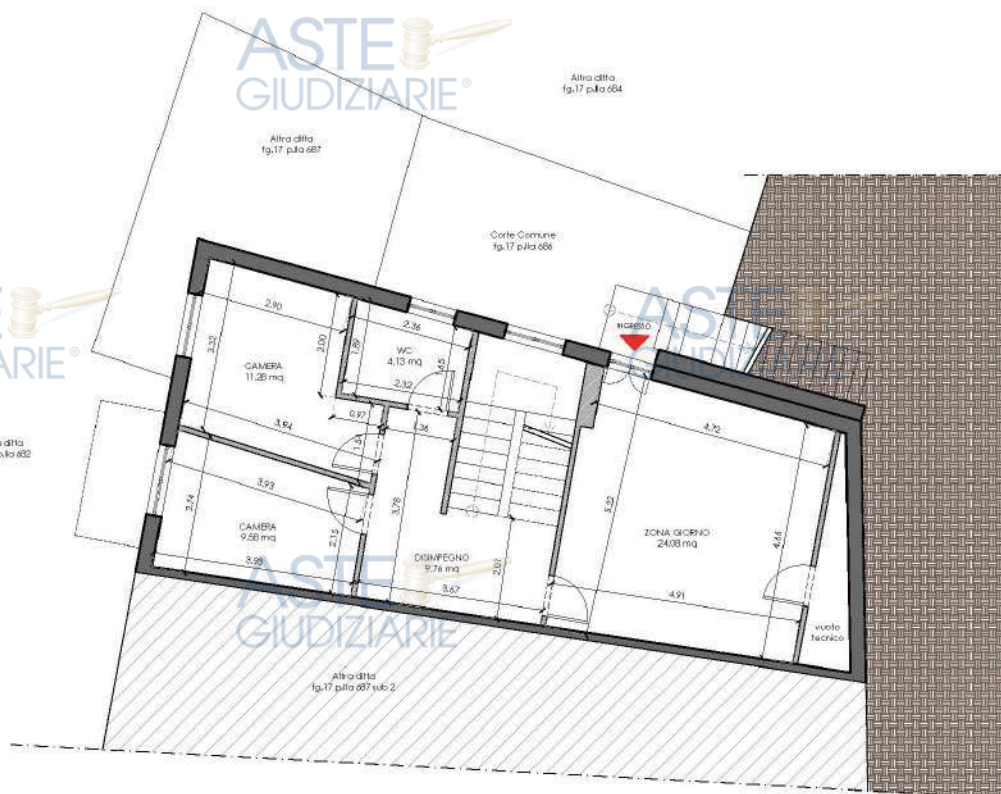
Rilievo Lotto Unico Stato di fatto _ pianta piano seminterrato (Allegato 6E)
